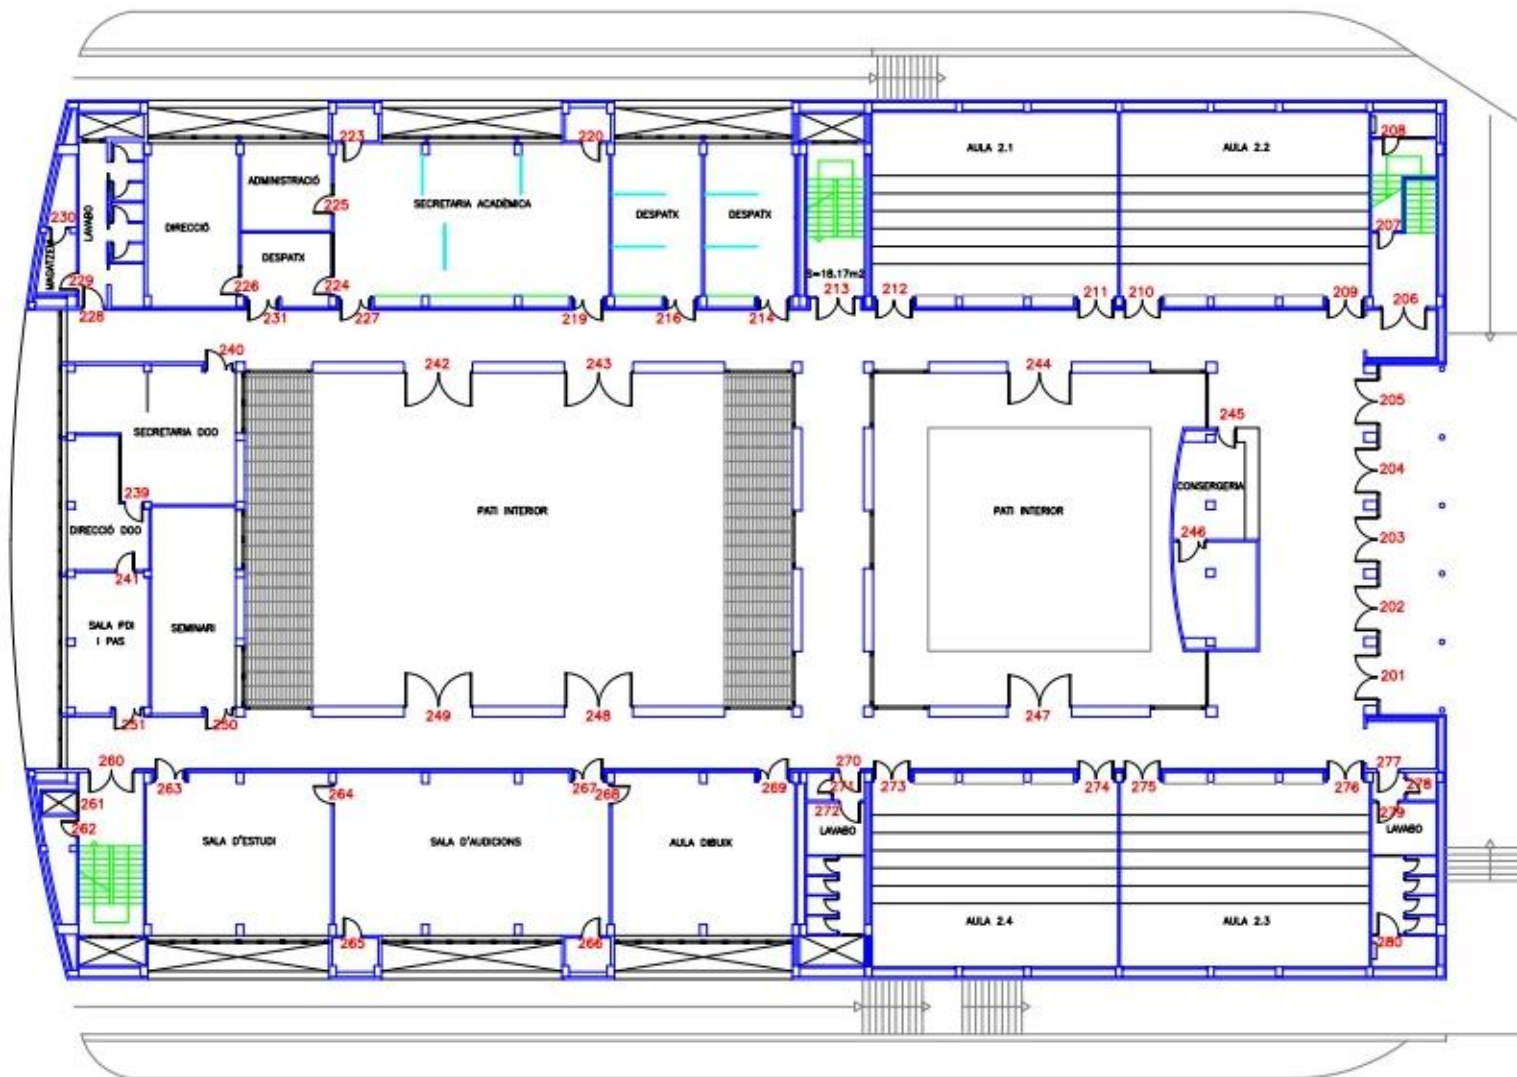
Pla de la planta 2 de la FOOT^G.
